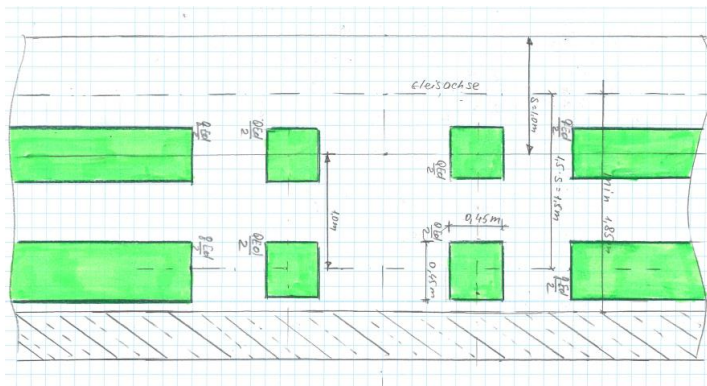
Entgleisungslastmodell 1 (Grundriss)
